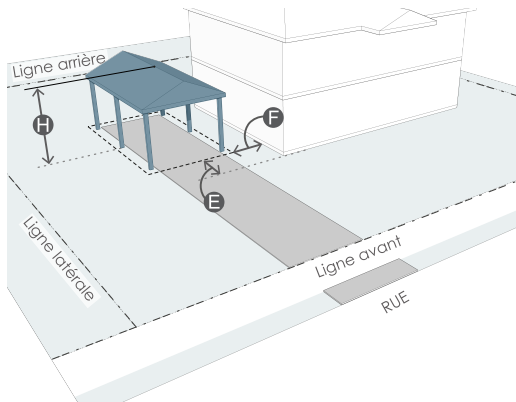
Distance minimale du bâtiment principal, retrait minimal par rapport au plan principal de la façade principale avant et hauteur maximale d'un abri d'auto
